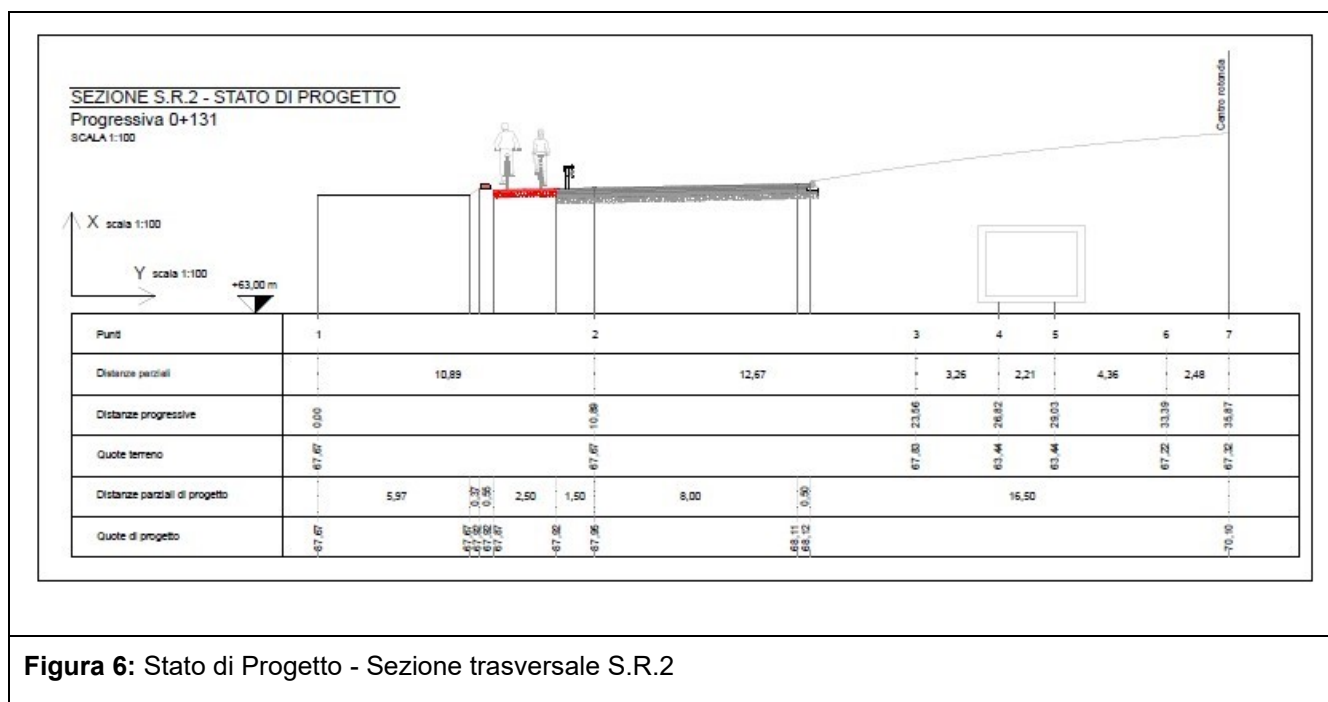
Stato di Progetto - Sezione trasversale S.R.2
